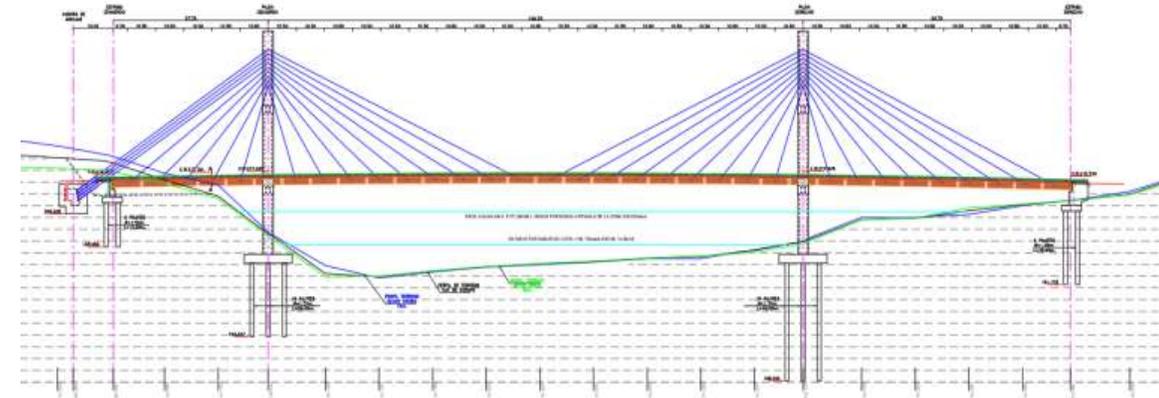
Vista en elevación de Puente Atirantado Cabo Leveau
